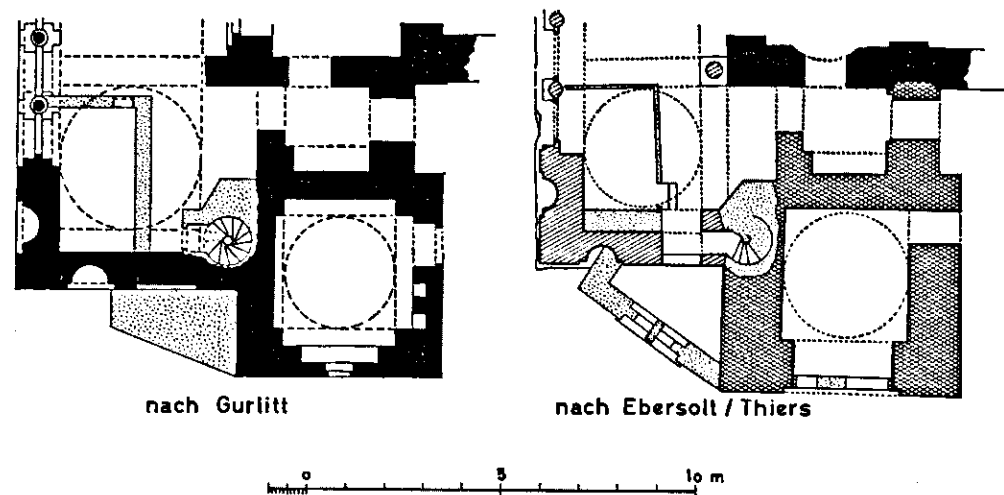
Kilise camii. Grundriß des südlichen Annexbaus mit angrenzendem Joch des Exonarthex nach Gurlitt und Ebersolt - Thiers
